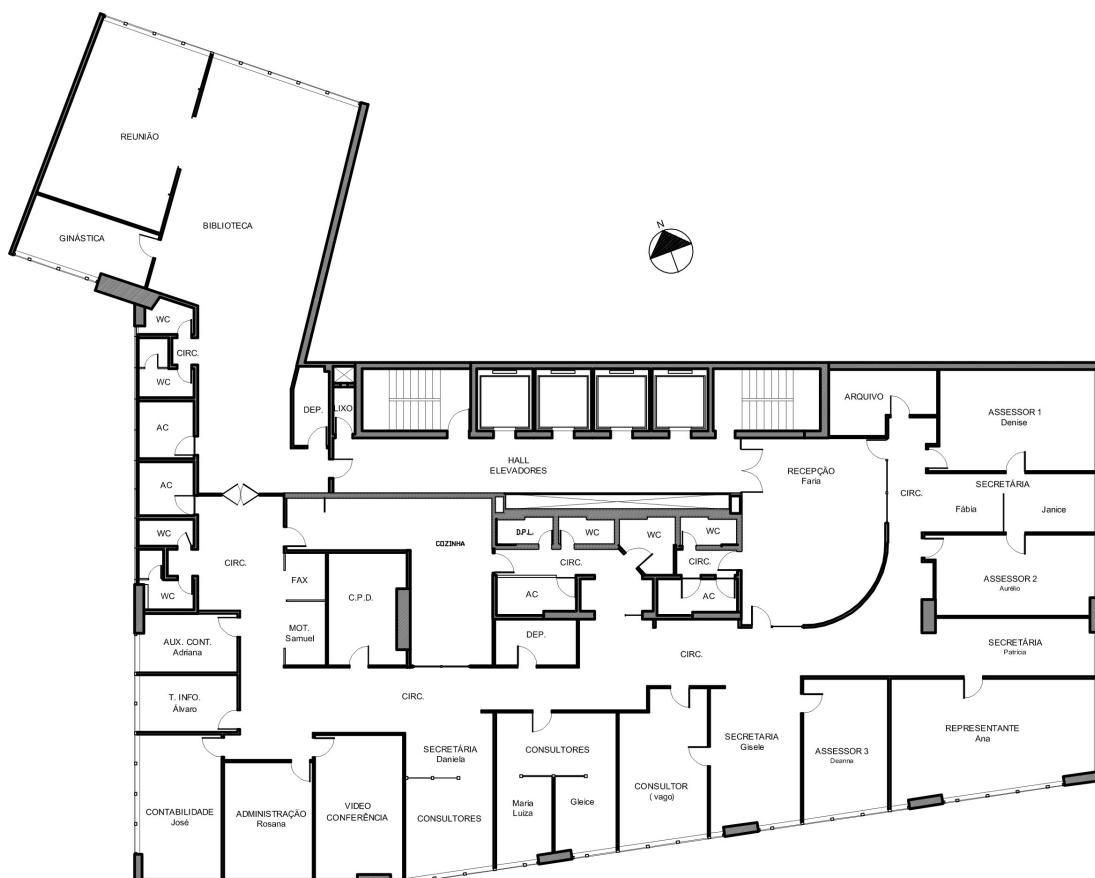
Planta Baixa do Escritório (GPAS, 2007)
